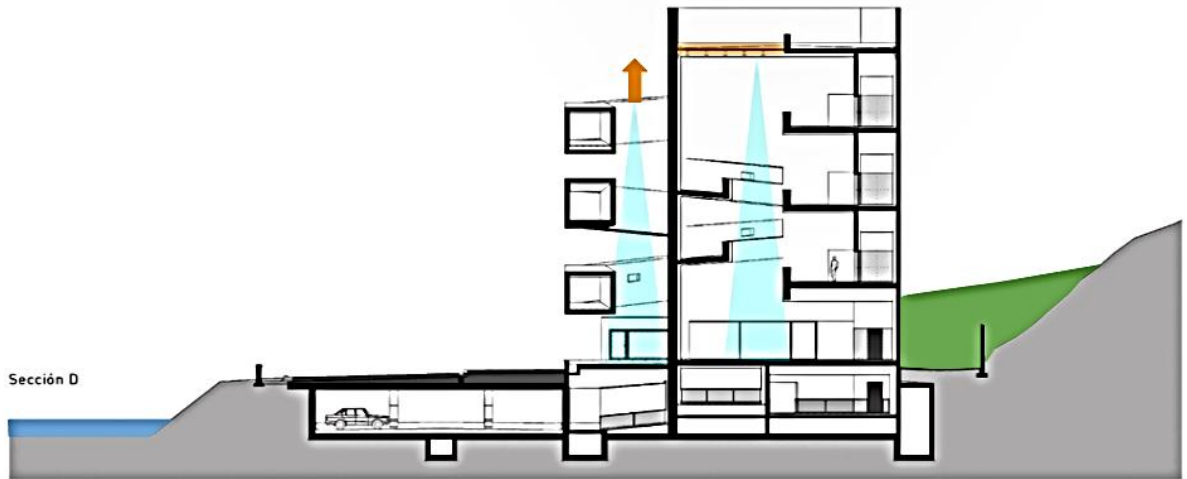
Plano en Corte intervenido, el atrio exterior abierto y el atrio interior cerrado
